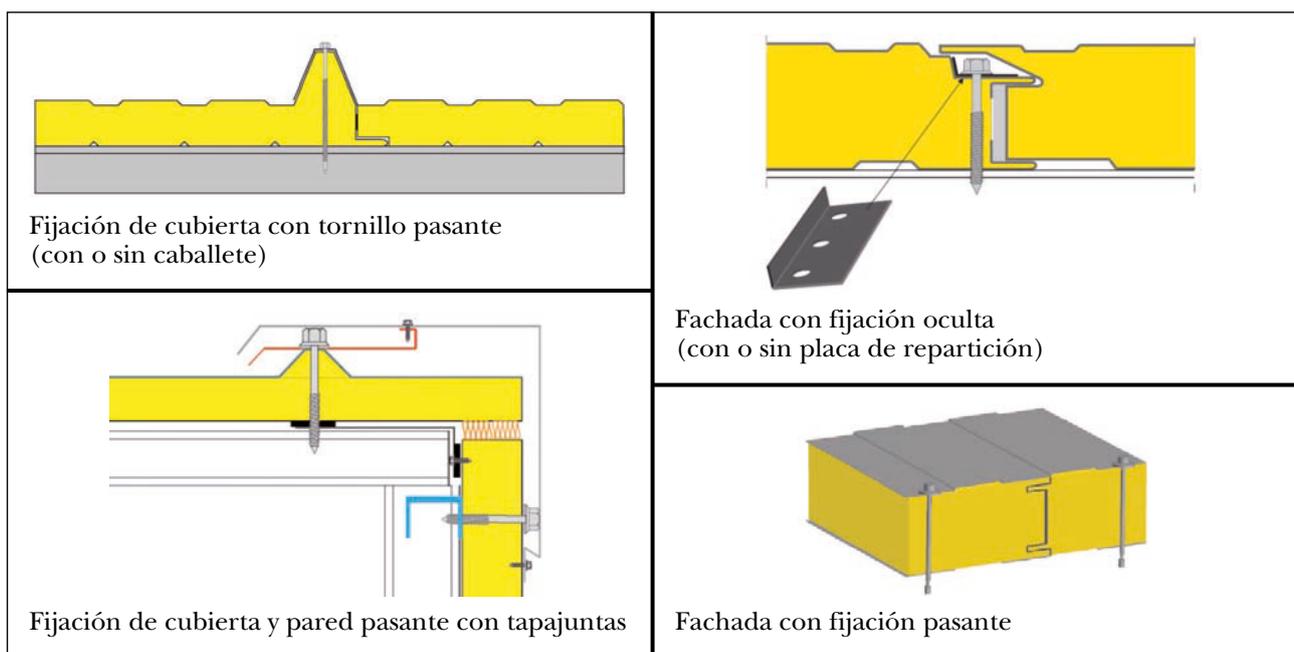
Ejemplos de tipos de fijaciones utilizadas en construcciones con paneles sándwich. Fuente: Cortesía de RAGE
